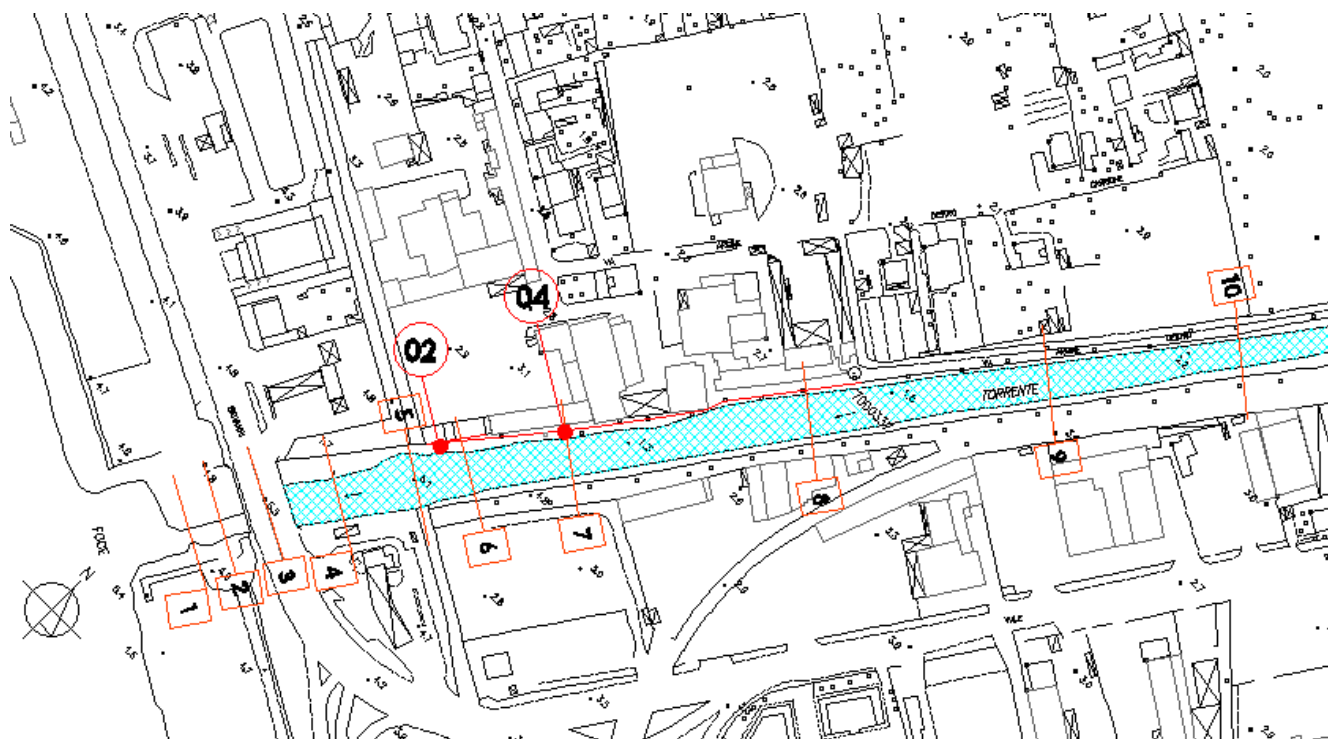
Inquadramento planimetrico – Tratto 01 – Sponda destra
